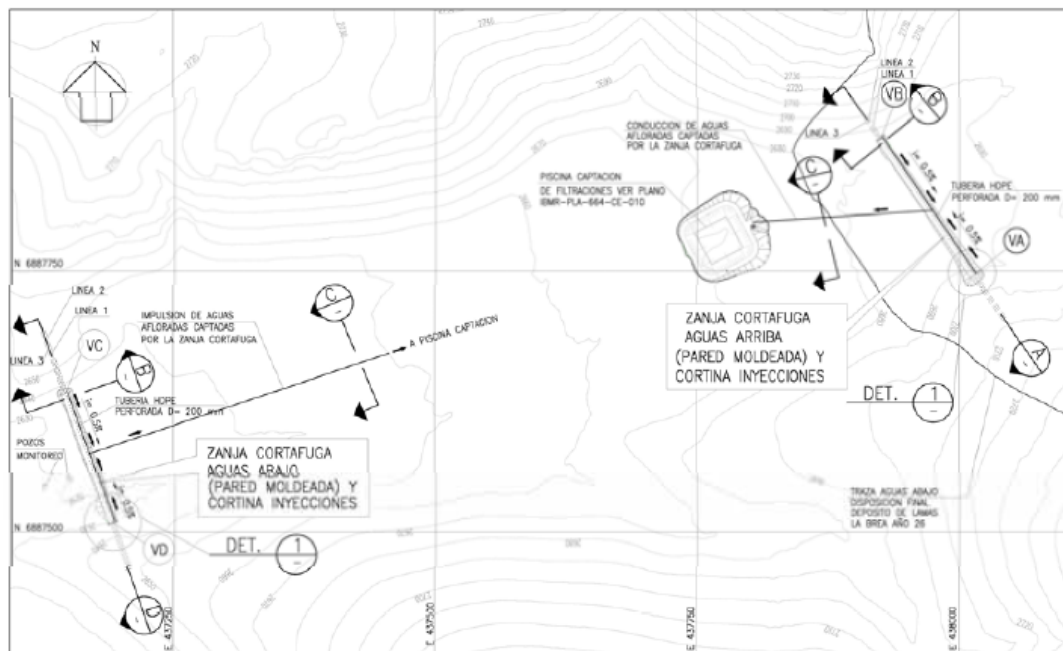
Ubicación en Planta Zanjas Cortafuga y Cortinas de Inyecciones (Ref. 7)
